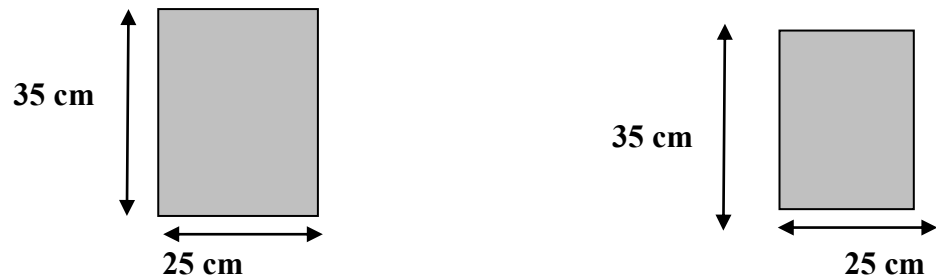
Dimension des Poutre principale, secondaire, Poutre Palière et Poutre de chaînage
